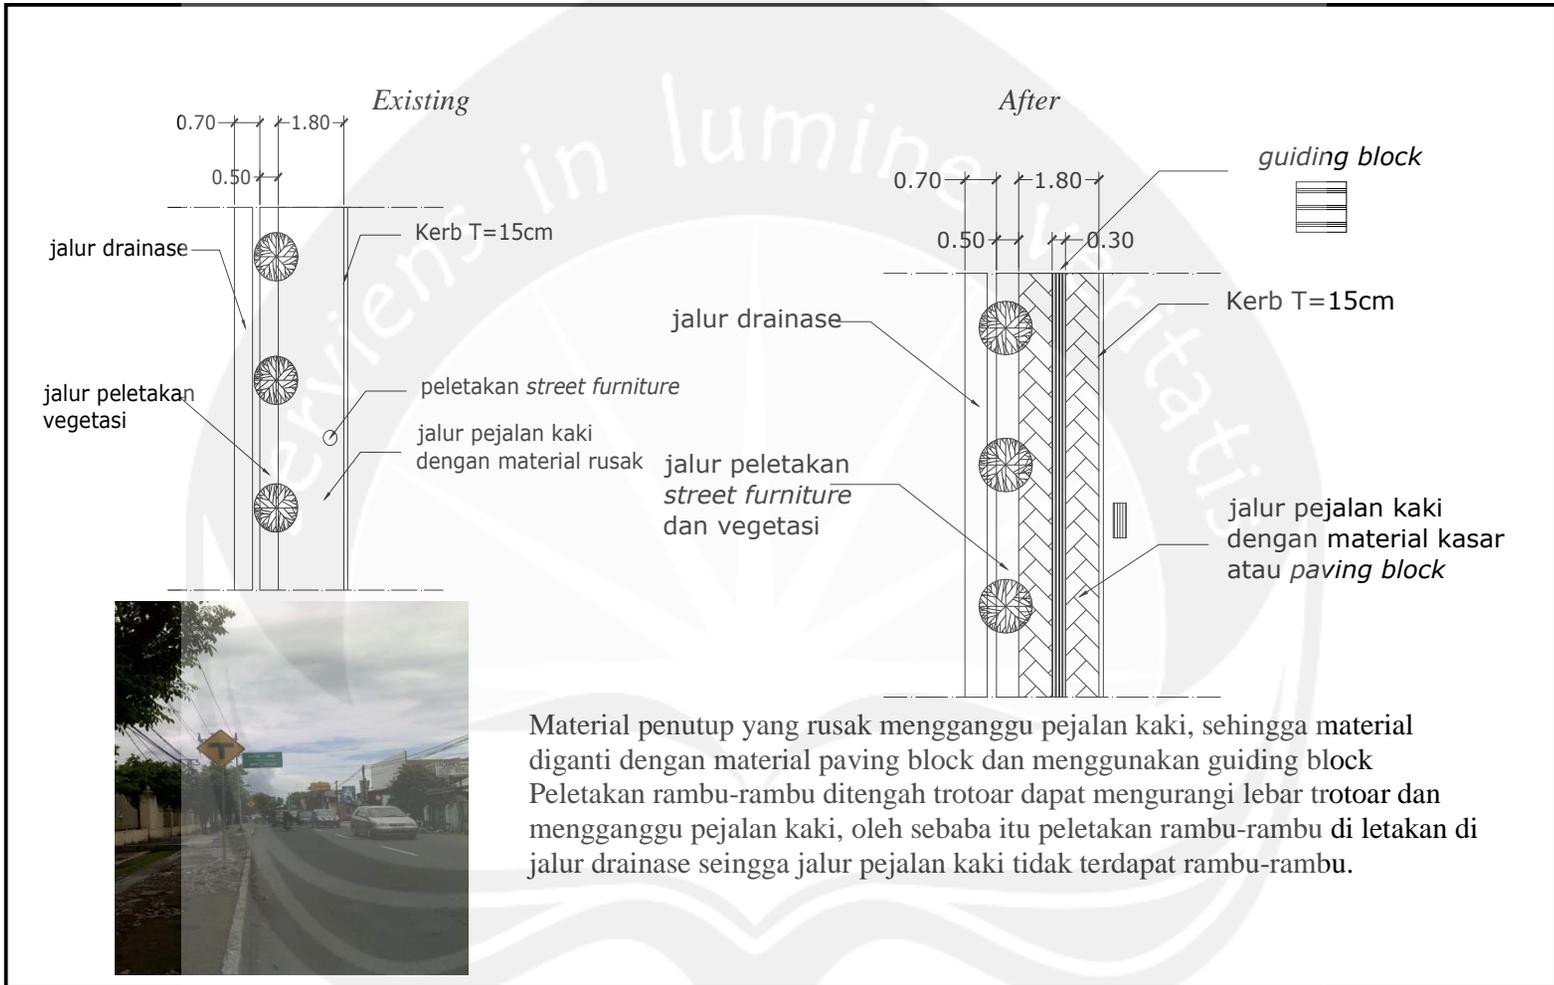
Potongan Desain Pada Jalur Penyebrangan
